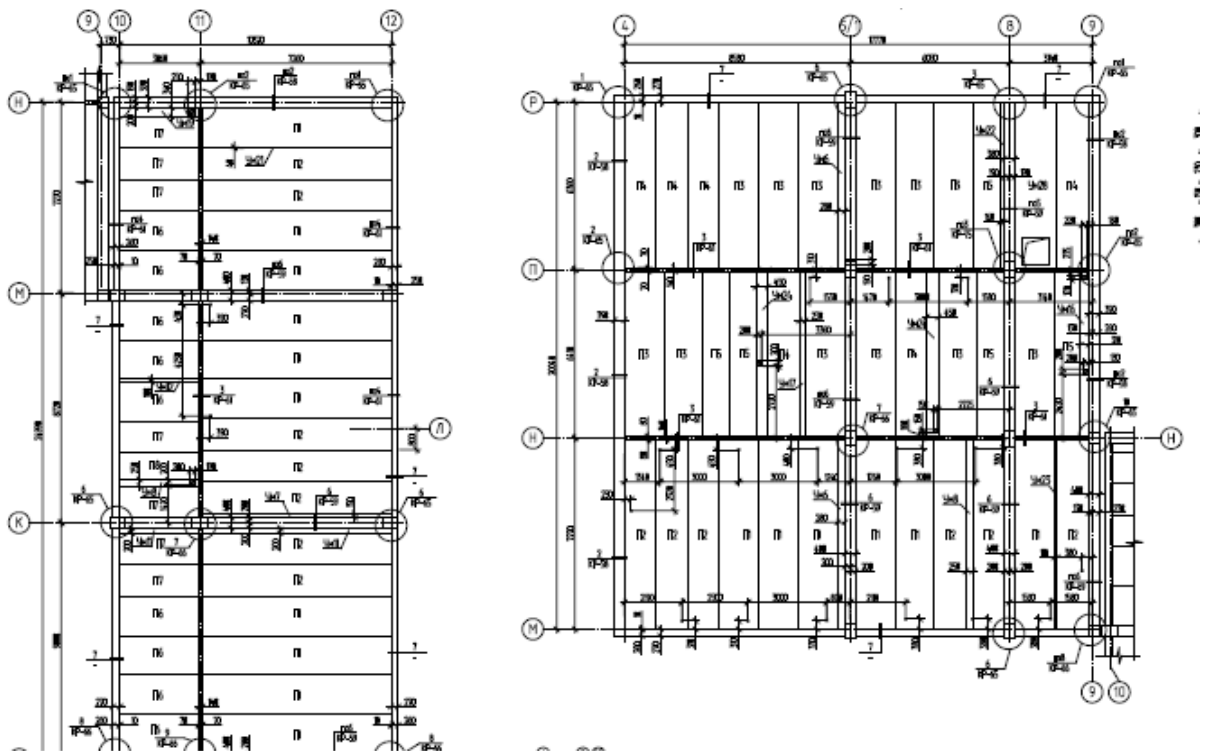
Схема расположения плит перекрытия и антисейсмического пояса на отм. + 6,300 в осях И-Н, 10-12; М-Р 4-9
